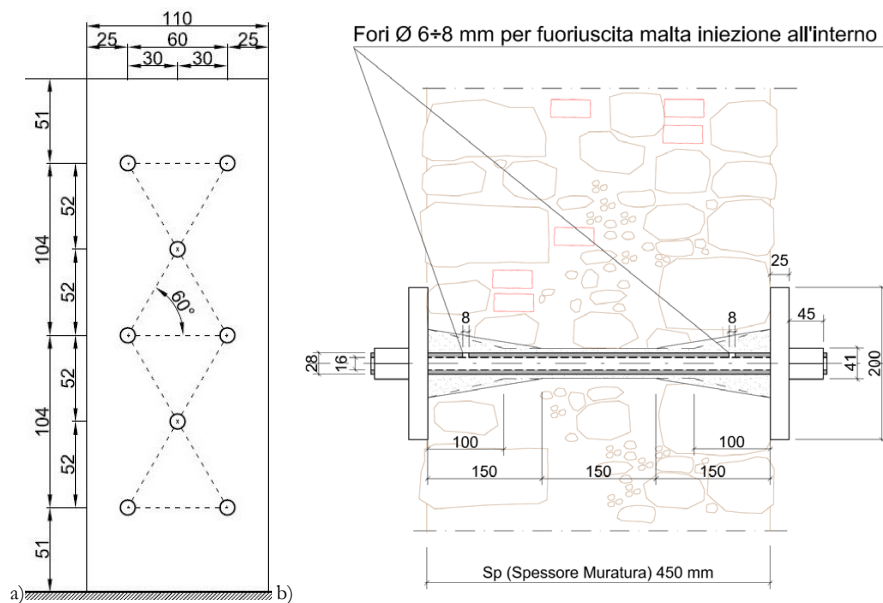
Idea progettuale; a) elevato strutturale pannello schema disposizione diatoni; b) dettaglio sezione trasversale posa in opera diatono.
